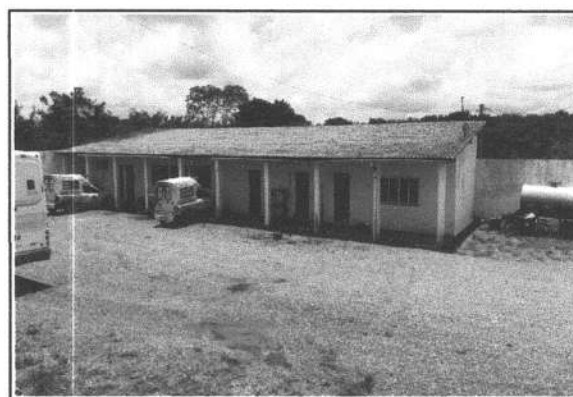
FACHADA BLOCO ADMINISTRATIVO
